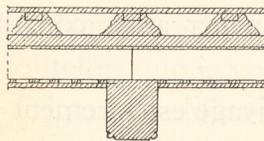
Plancher sur poutres apparentes en contre-bas des solives.
